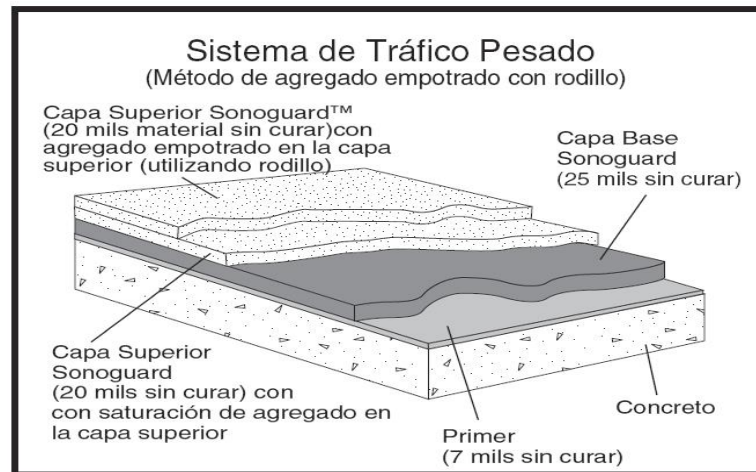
Sistema de tráfico pesado. Fuente: construcción de los autores
